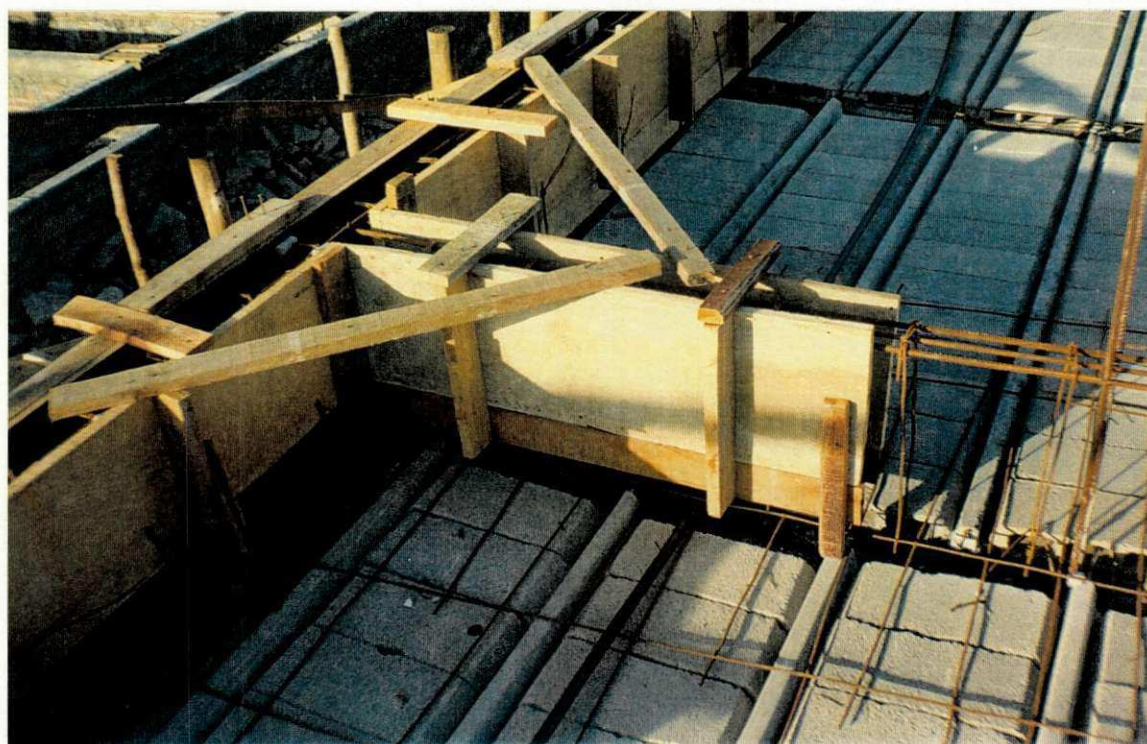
Preparação das extremidades das vigas internas para concretagem
